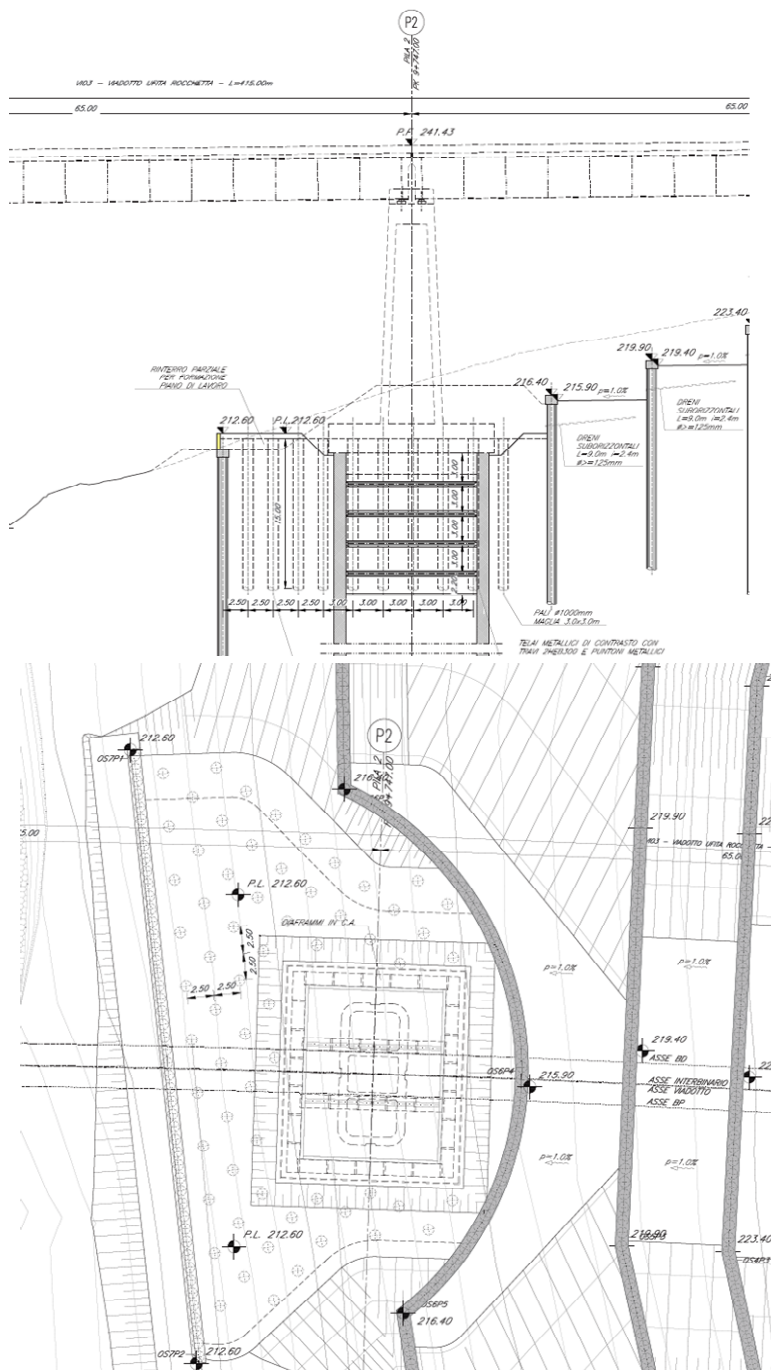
P2. Sezione longitudinale e pianta di riferimento
